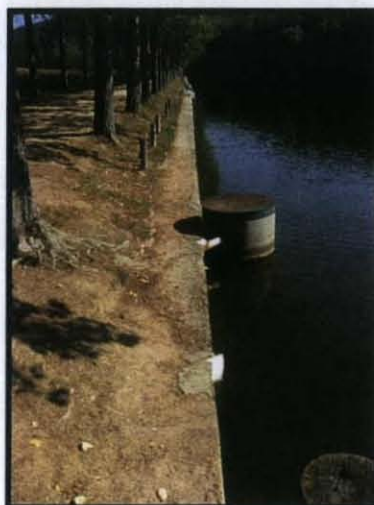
Buse déversoir, passerelle, volant à crémaillère et dégrilleur
